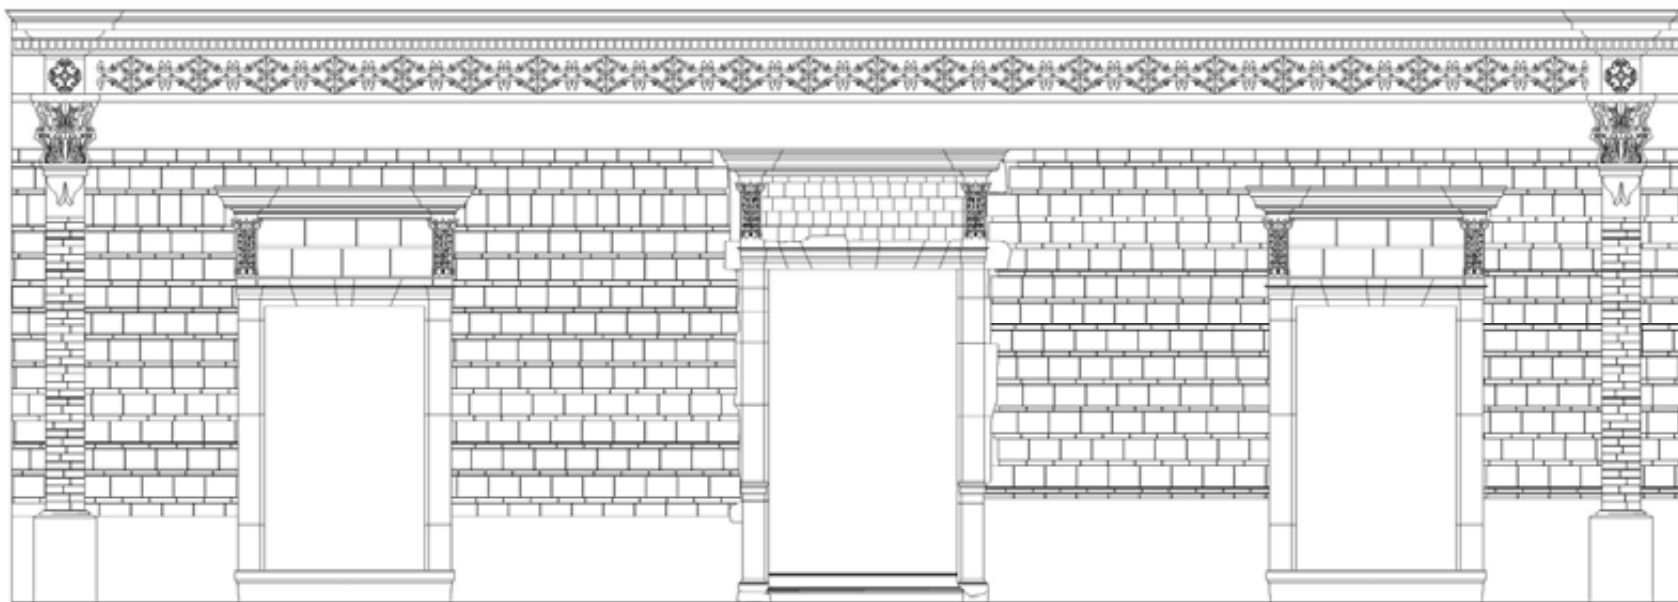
Fachada principal de la casa “González Torres” estado actual.
